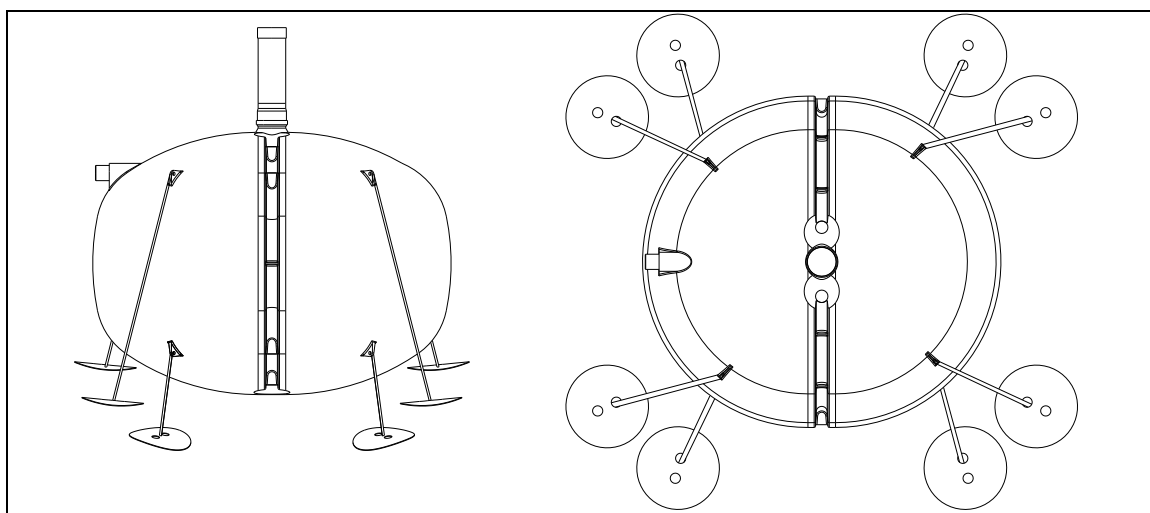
Крепление на нескольких монтажных плитах из стеклопластика емкостей LOKA 4000/3100 и 6000.
